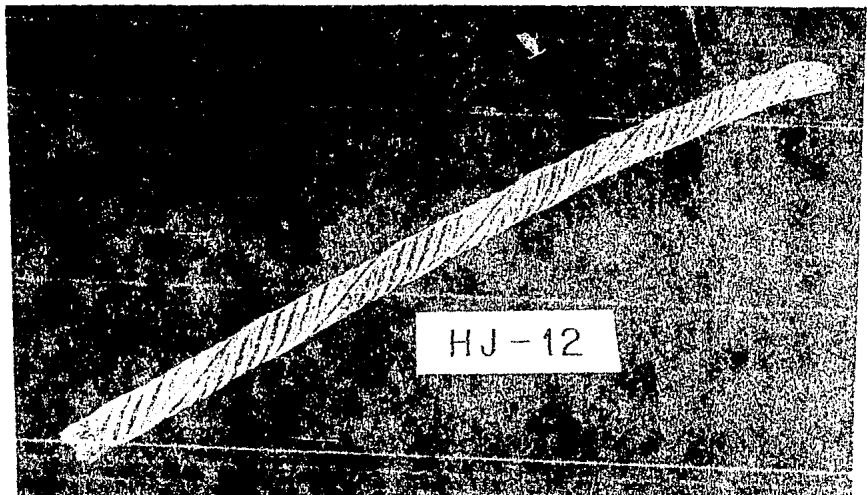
MUESTRA HJ-12, SE OBSERVA LA FRACTURA EN LA PARTE INFERIOR IZQUIERDA, AL PARECER NO EXISTIO FLEXION.
